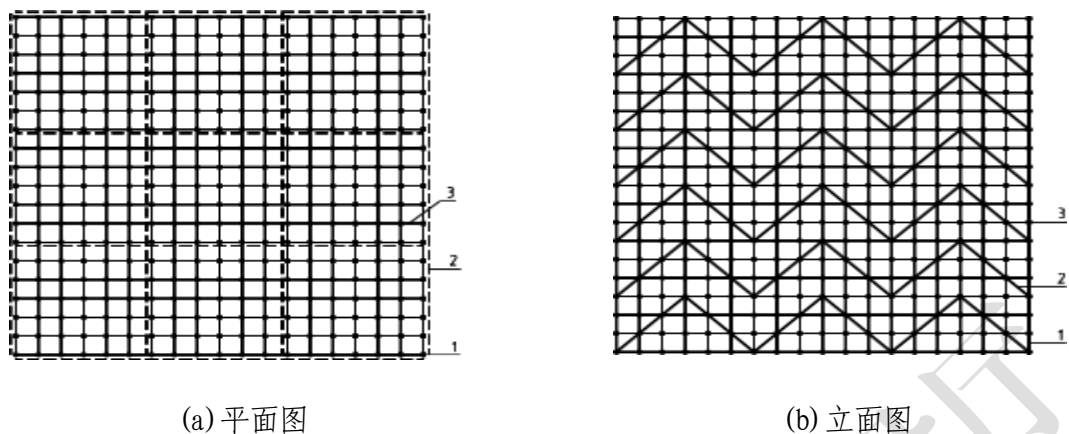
竖向斜撑杆布置示意图 (二)
